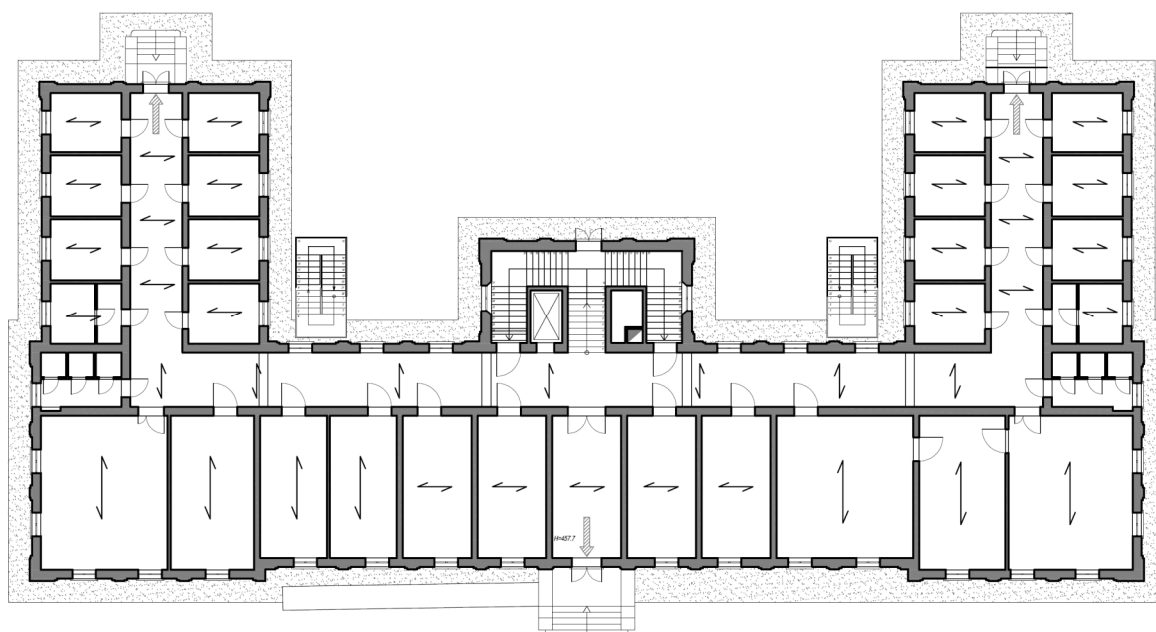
Planimetria piano terra del Padiglione Morselli
